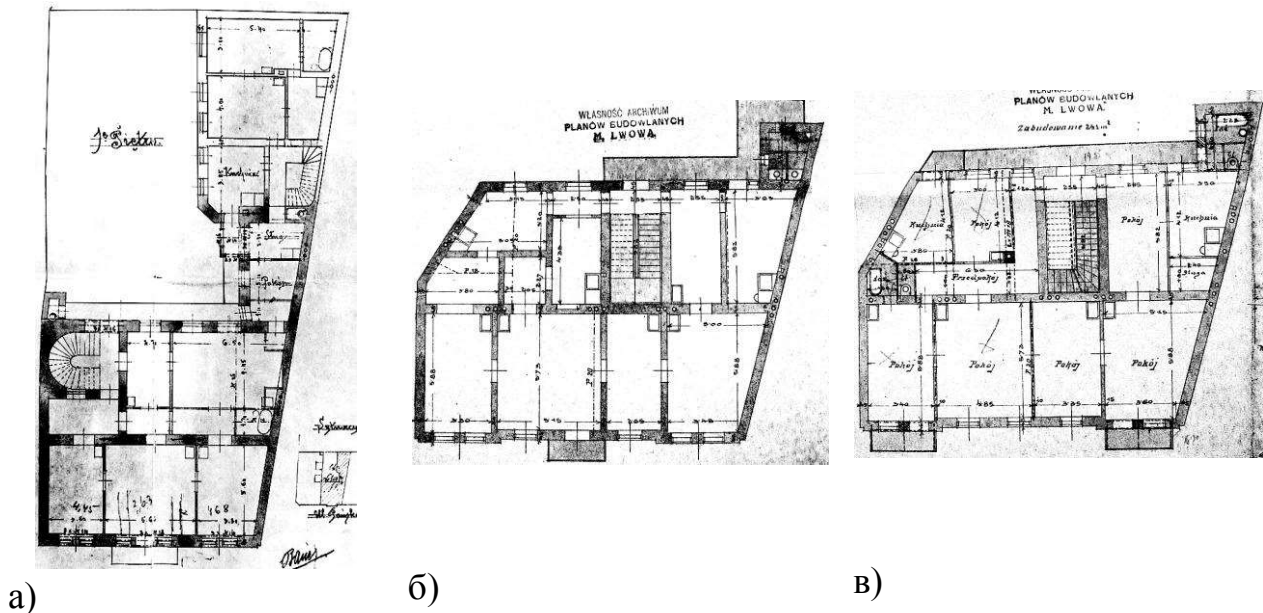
Проекти реконструкції багатоквартирних будинків кінця ХІХ – початку ХХ ст.: а) план другого поверху (прибудова флігеля) вул. І. Франка, 7 відповідно до проекту 1911 р. (арх. В. Раух та В. Бауер) [7]; б) план другого поверху; в) план третього (надбудованого) поверху вул. Шептицьких, 6 відповідно до проекту 1928 р. (арх. І. Корнхабер) [8]
